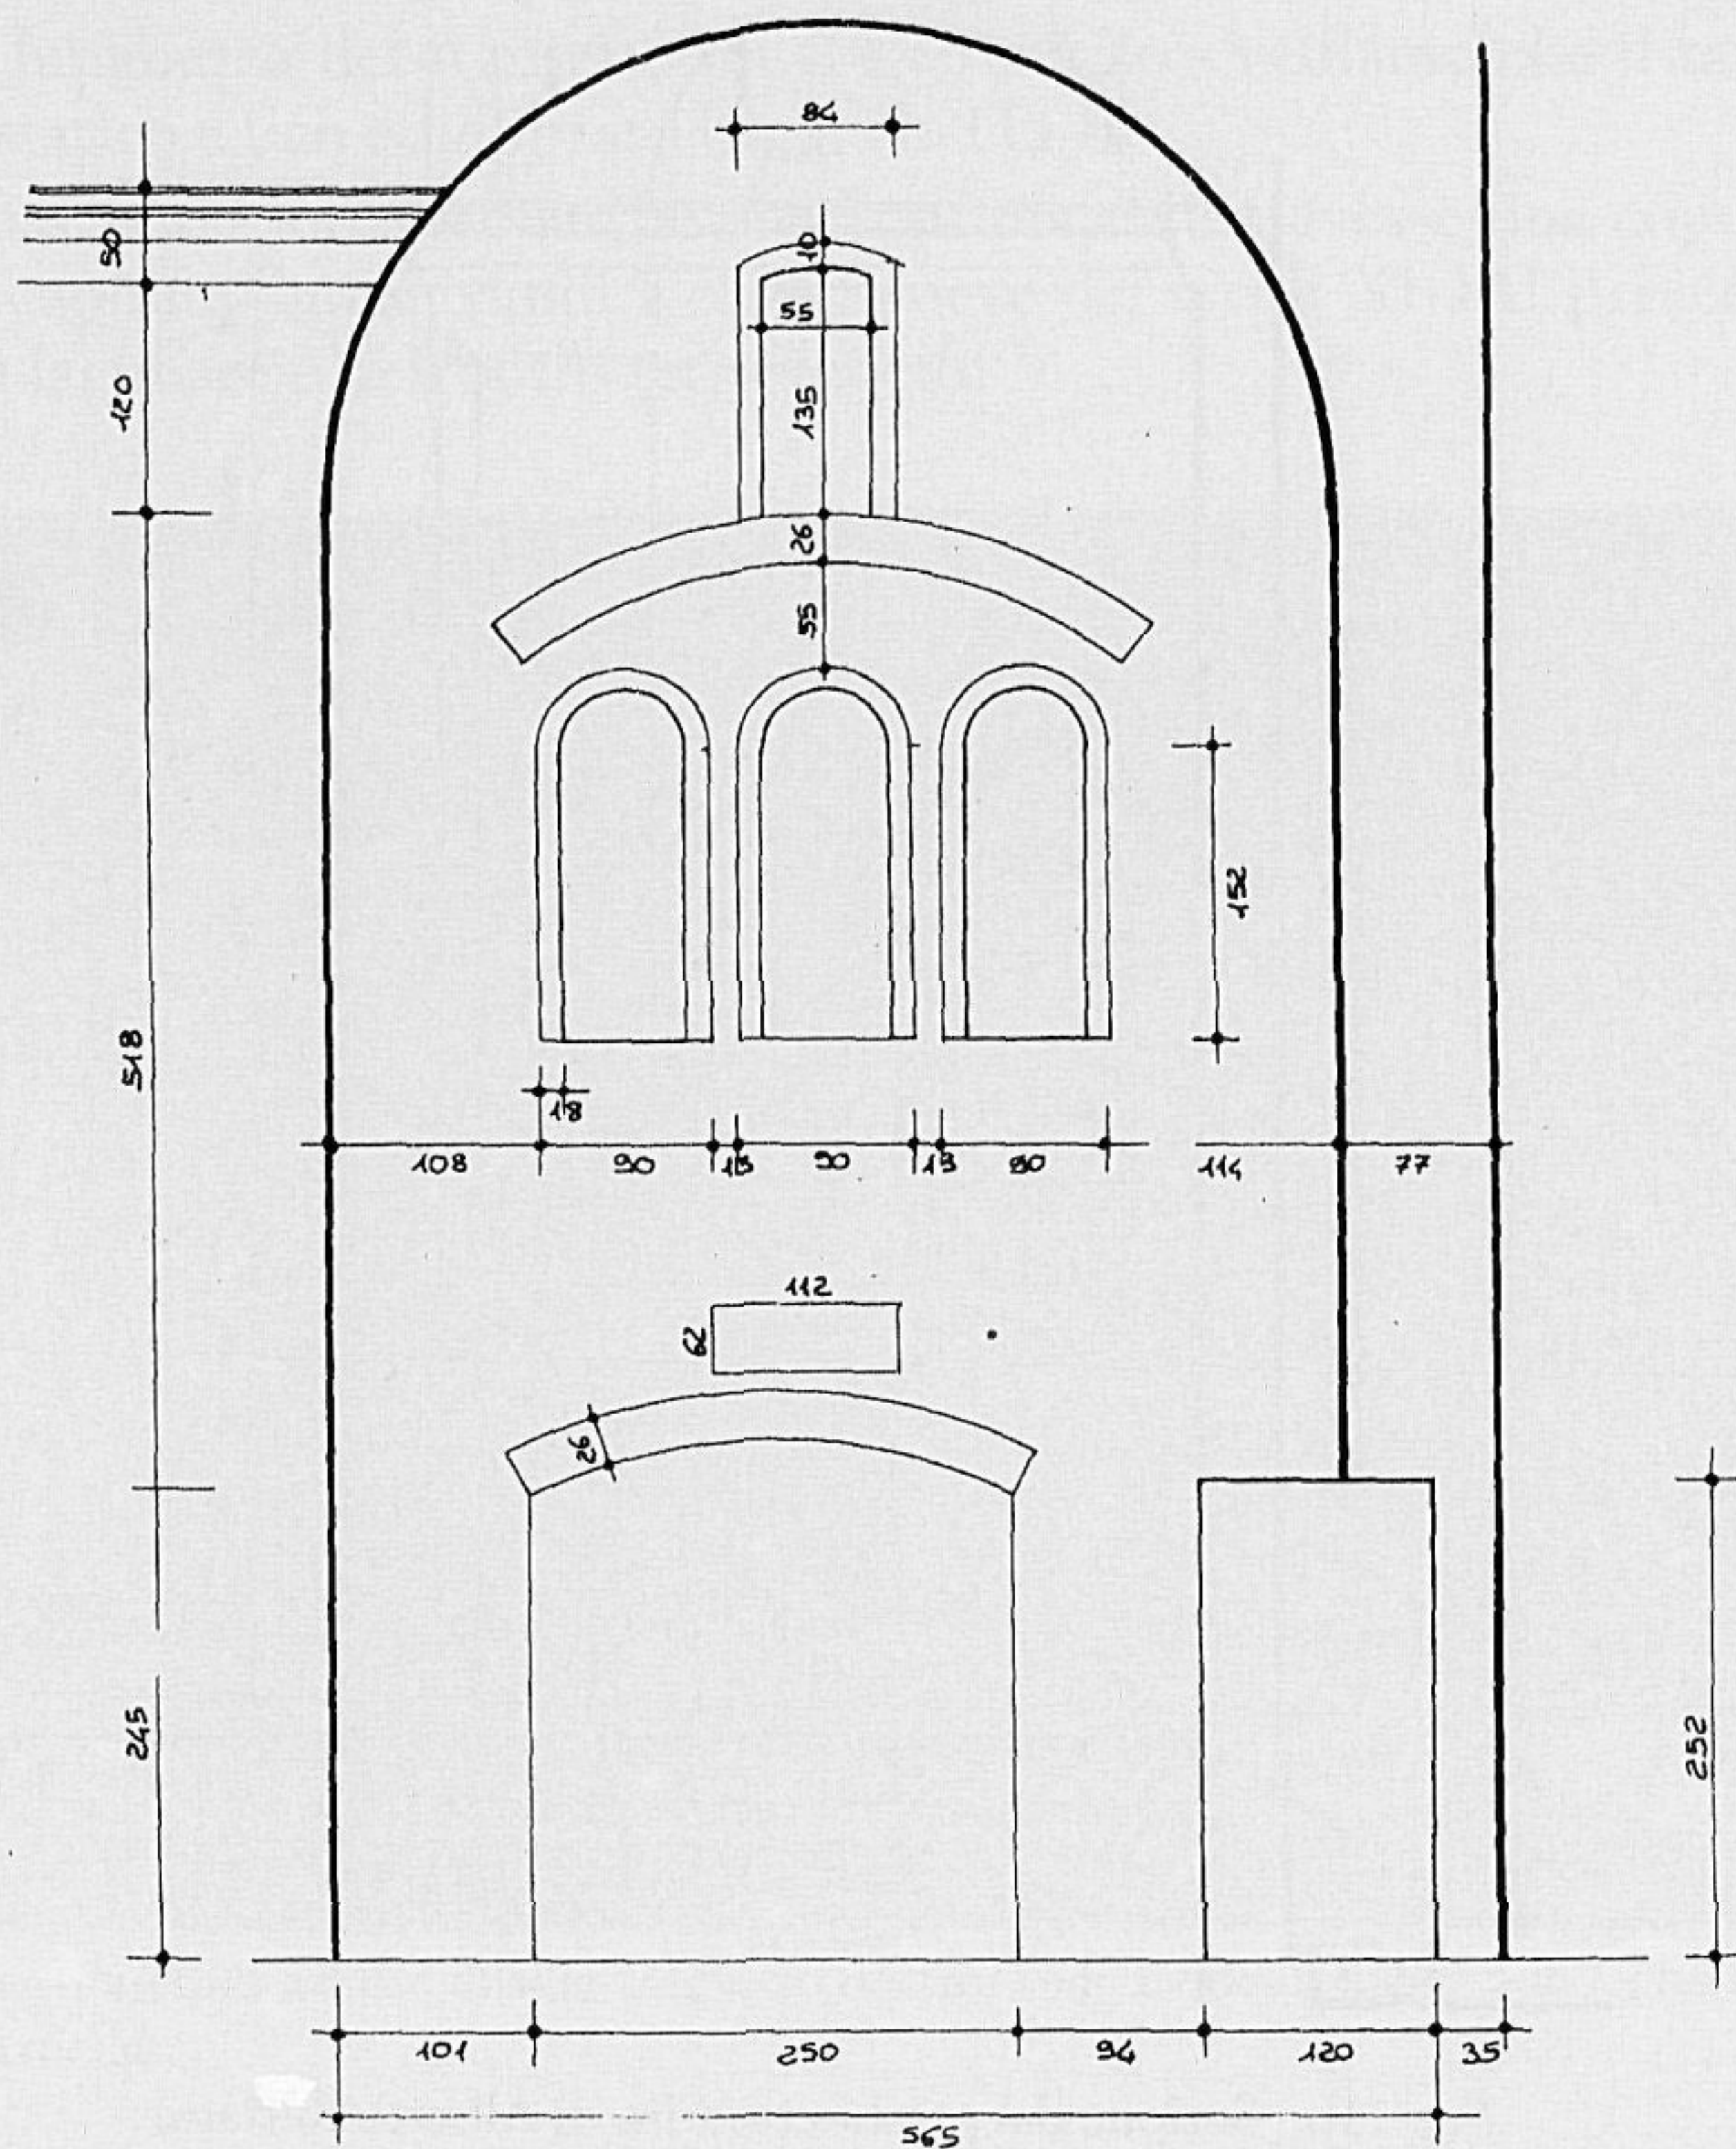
Prospetto parete sud (dis. di Alberto Ruffato).
